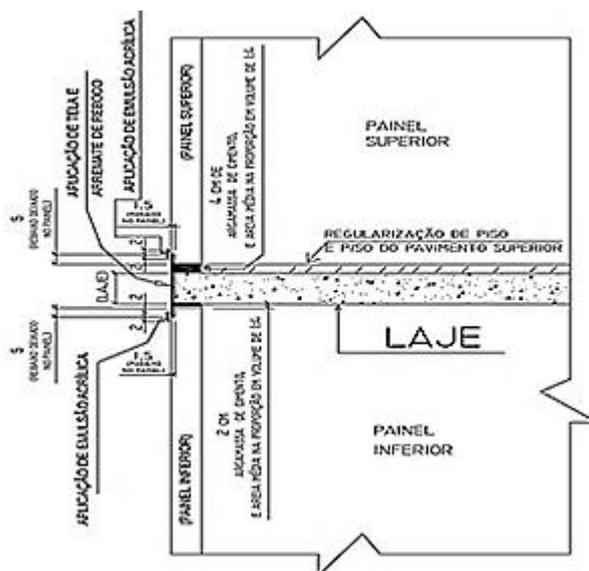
Desenho esquemático do encontro entre painéis e laje.
